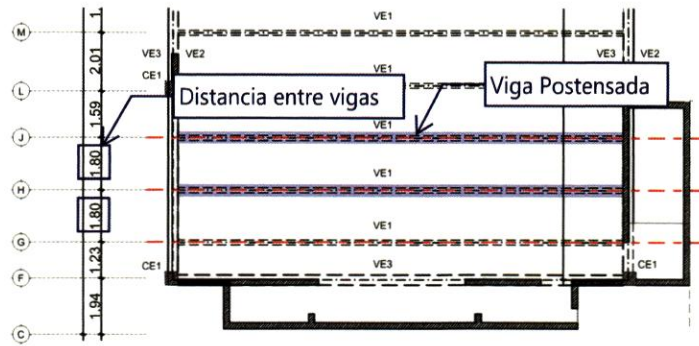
Planta estructural del techo elaborada por ONESVIE, ampliada y anotada para mostrar la separación indicada entre las vigas en los ejes H y J. Estos ejes se han extendido a la planta estructural con líneas rojas punteadas.
